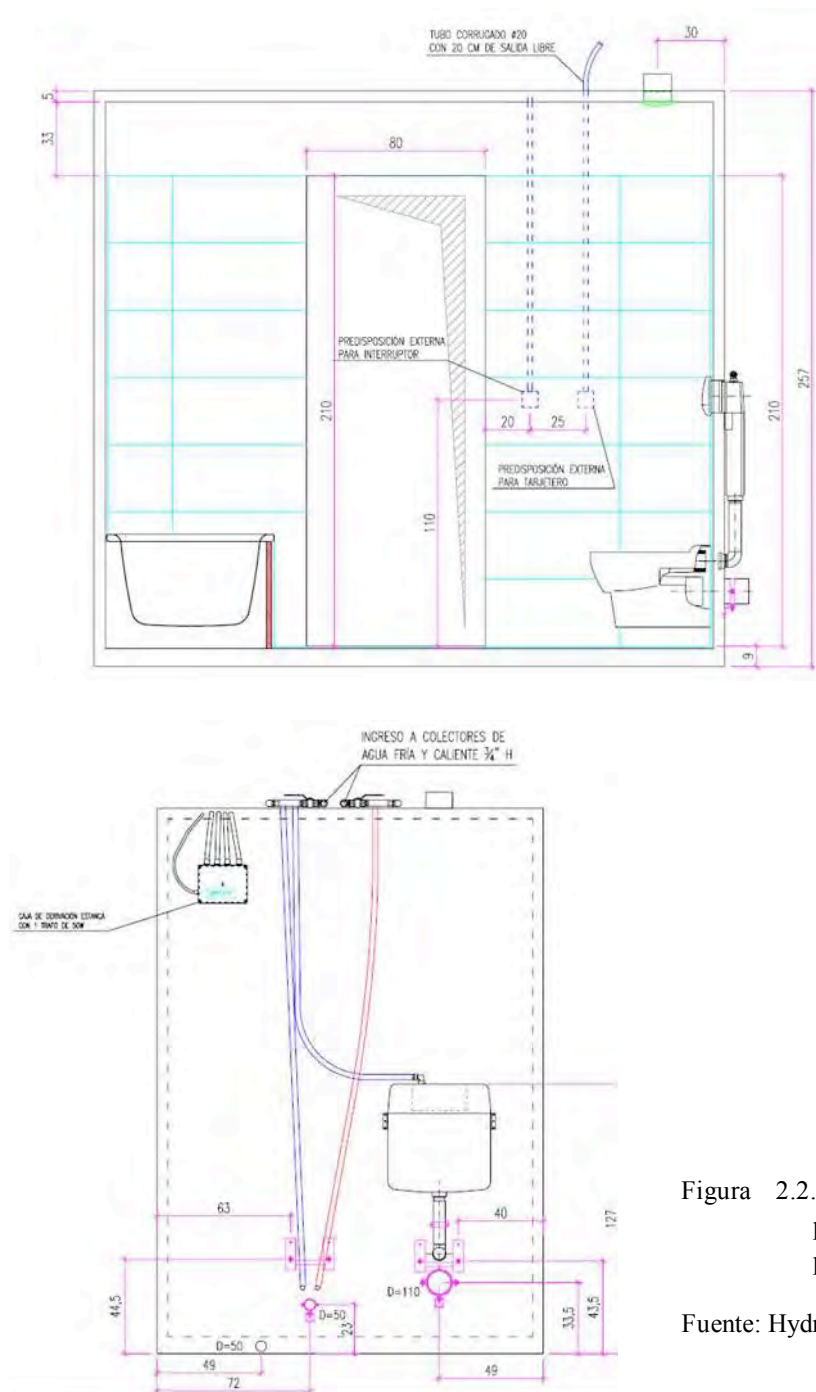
Planos de alzados de baño prefabricado para hotel en Sureste peninsular español
